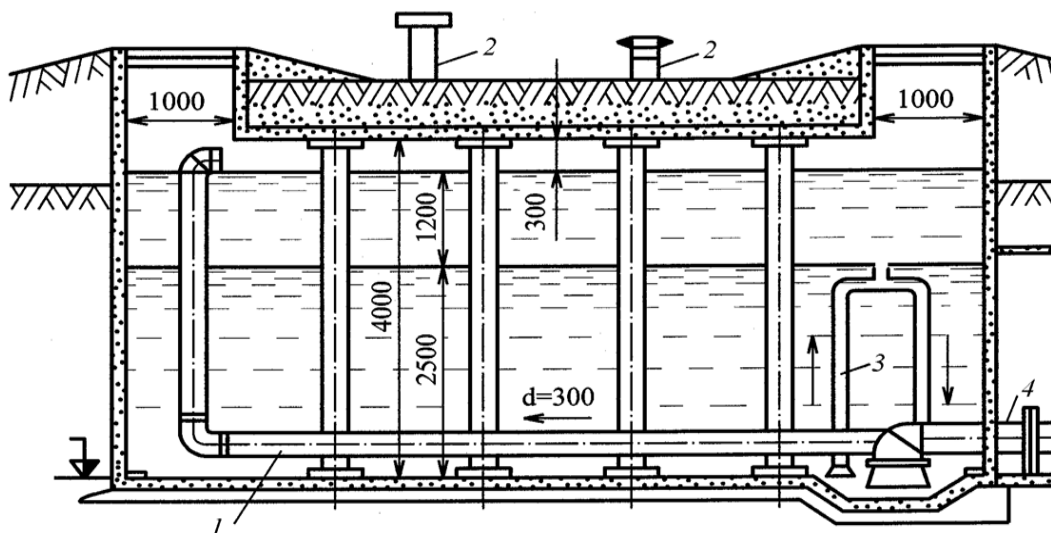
Устройство резервуара чистой воды: 1 - подающий трубопровод; 2 - вентиляционная труба; 3 - трубопровод отбора воды (всасывающий трубопровод хозяйственнопитьевых насосов); 4 - трубопровод отбора воды на пожаротушение
